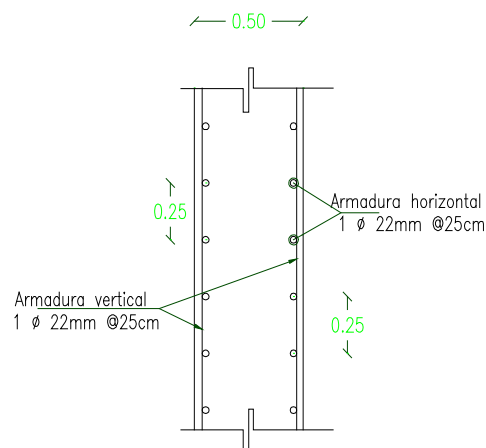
Corte típico de muro (Paredes de arriostramiento)
